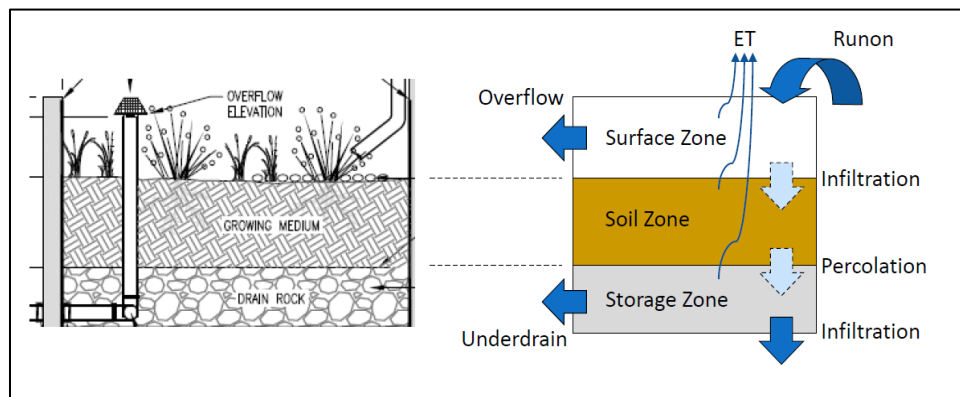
Sección tipo de jardín de Lluvia, (Fuente: de [6]).
